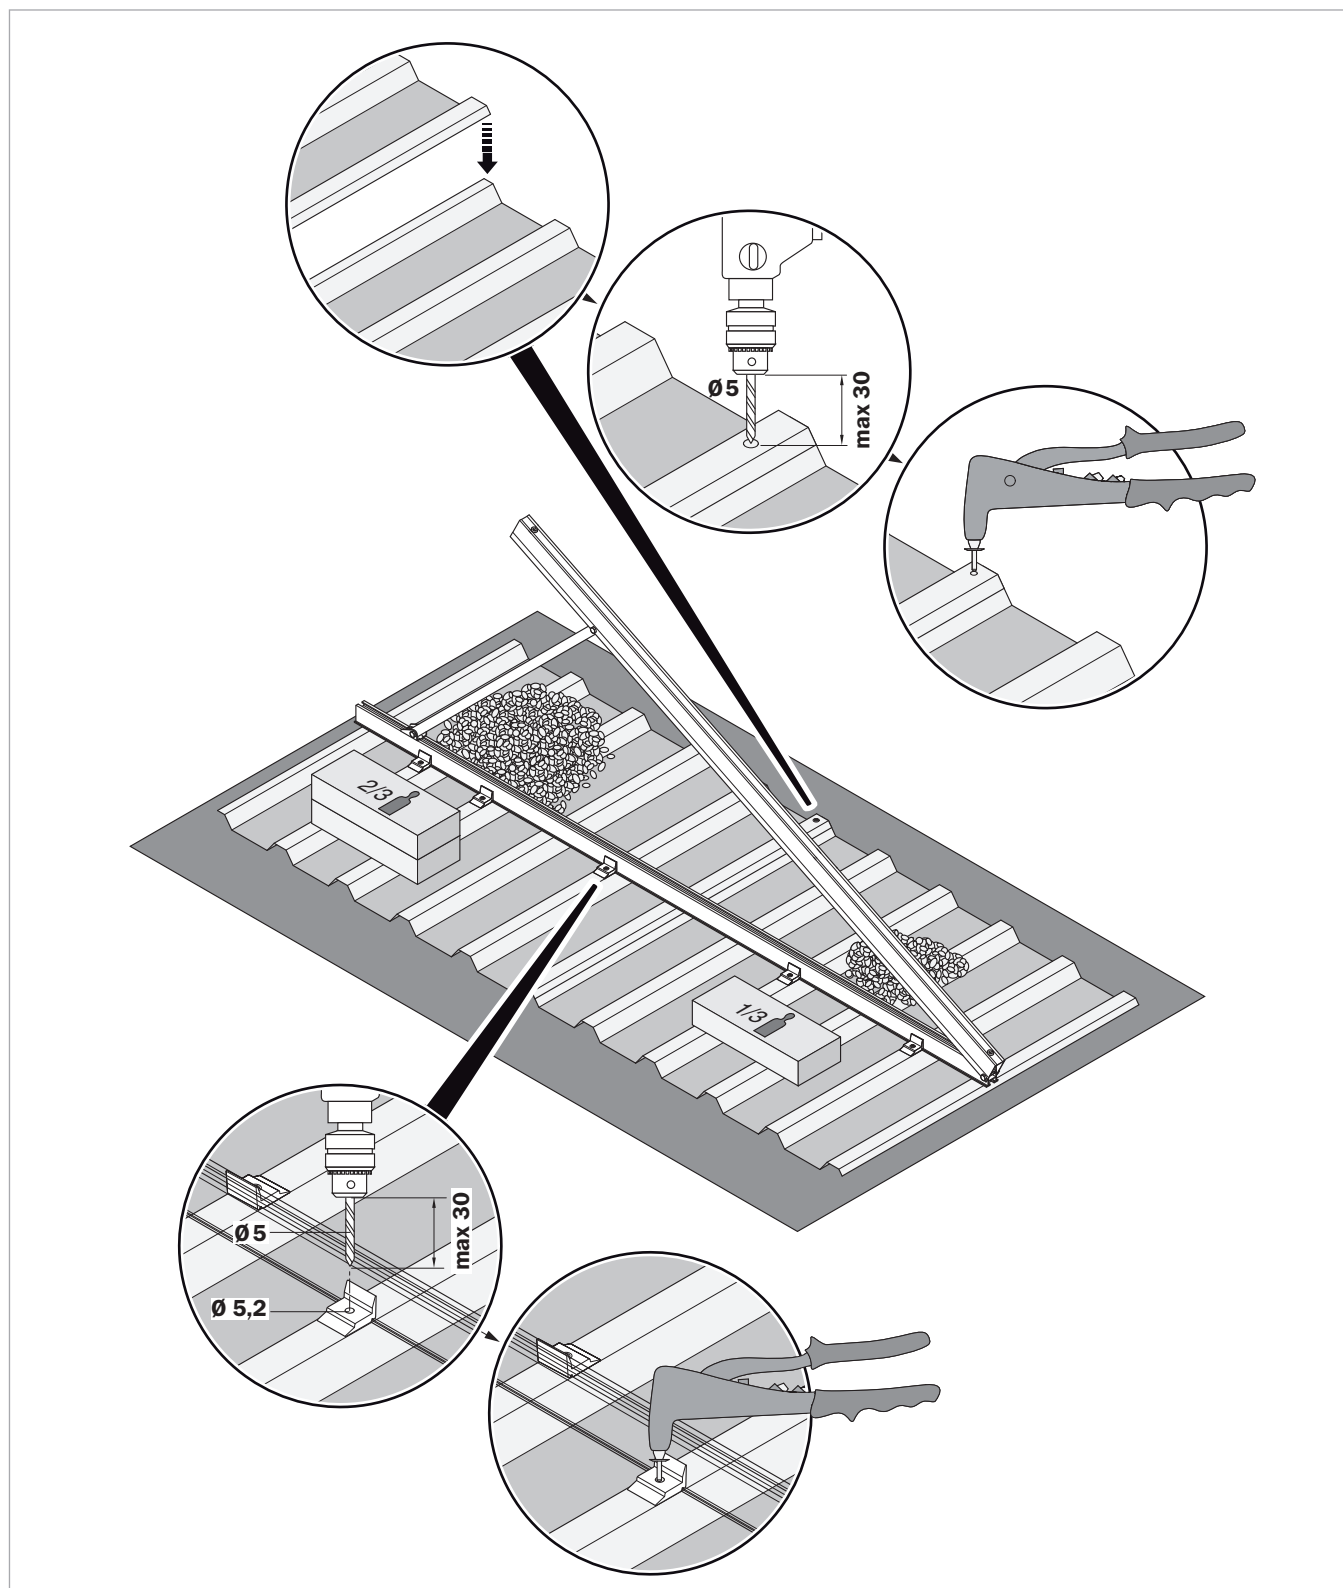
montage sur plaque à ondes trapézoïdales, avec kit de plaque trapézoïdale
